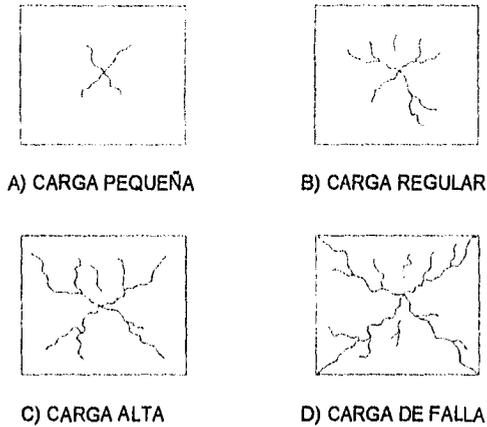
II.2 AGRIETAMIENTO CARACTERISTICO EN LOSAS PERIMETRALMENTE APOYADAS.
